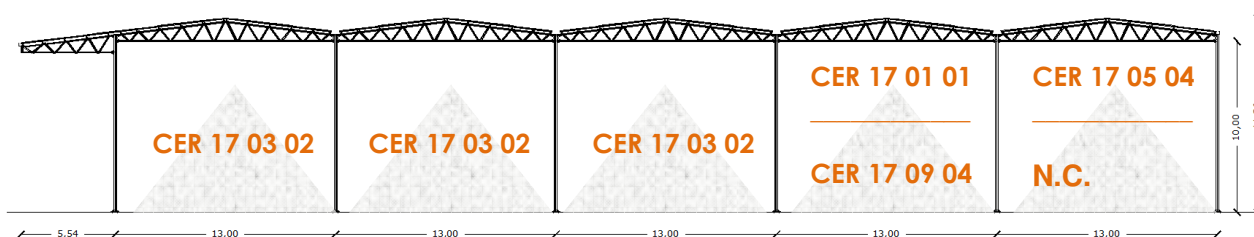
sezione pensilina 1 – schema dell'organizzazione interna della messa in riserva
